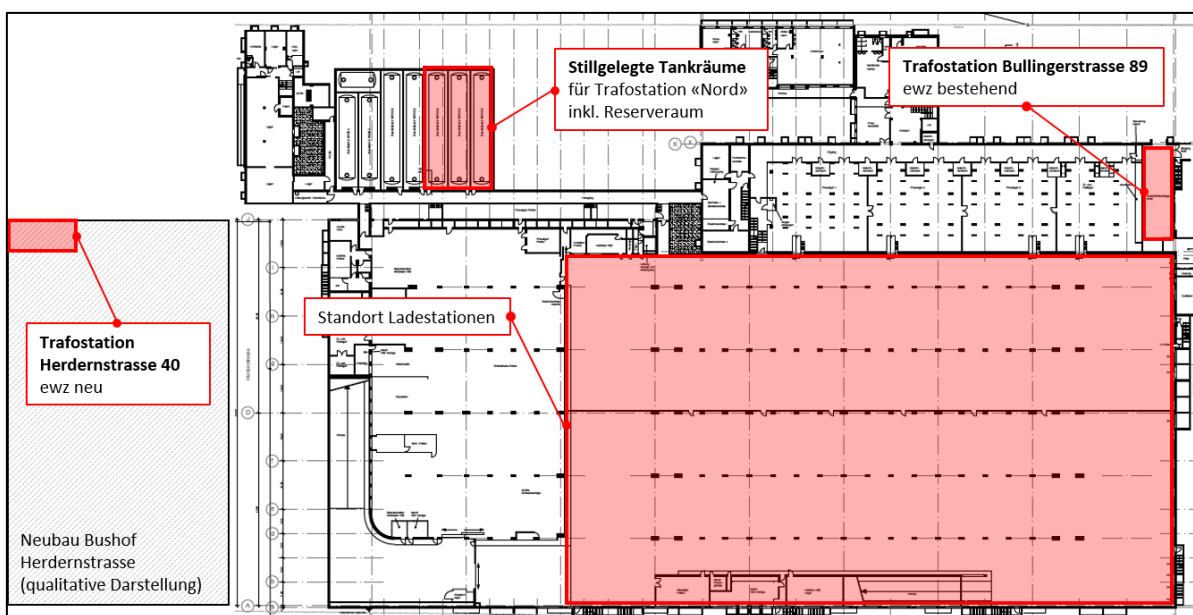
Grundriss UG Busgarage Hardau
